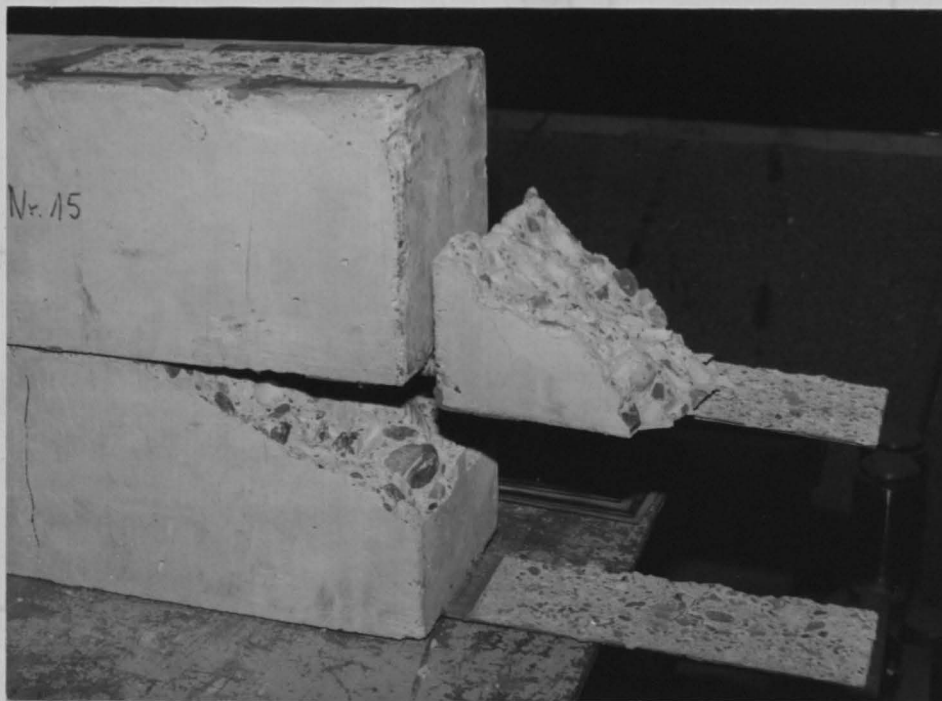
Bruchbild des ebenen Versuchskörpers mit Bruchkeil
